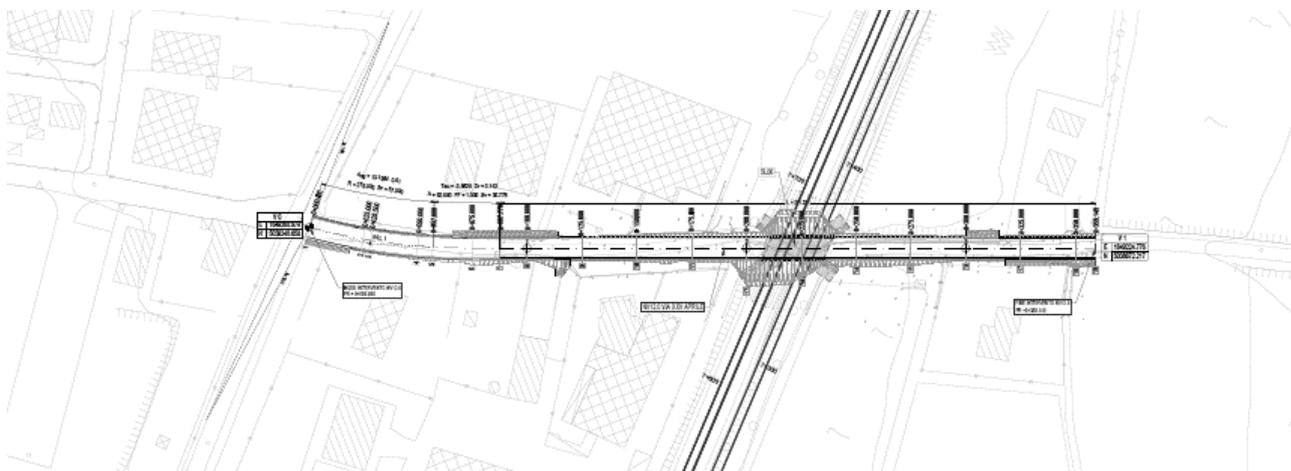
NV12 – Stralcio planimetrico su rilievo Via XXV Aprile
